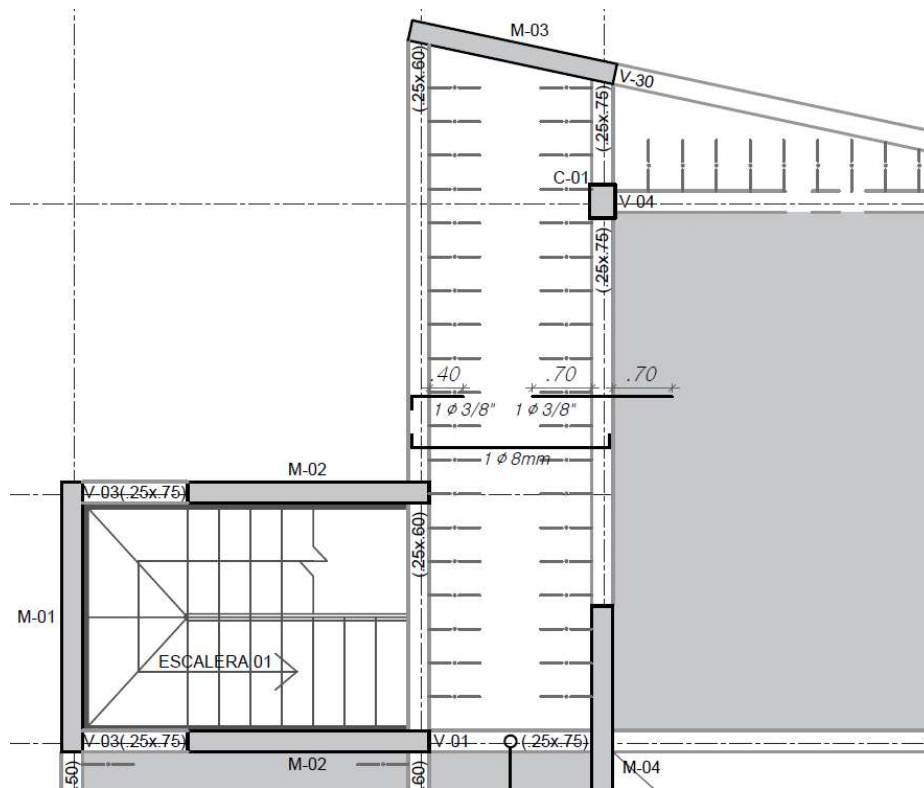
Armado de refuerzo para losa aligerada. Fuente propia.
